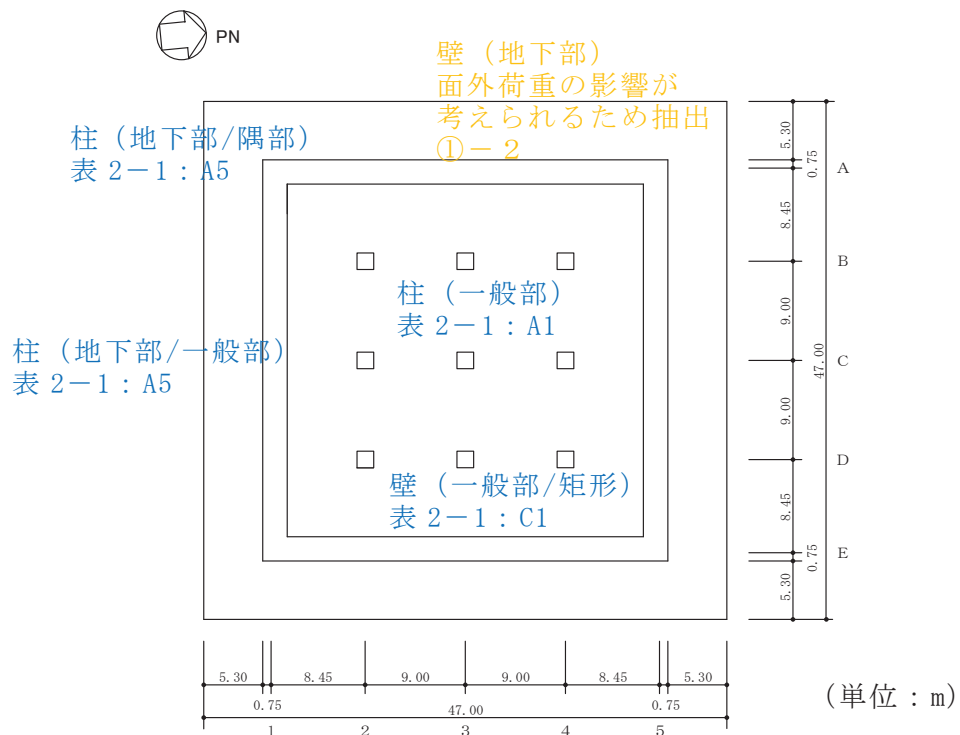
(1) 緊急時対策建屋の概略平面図 (0.P.* 51.5m)
